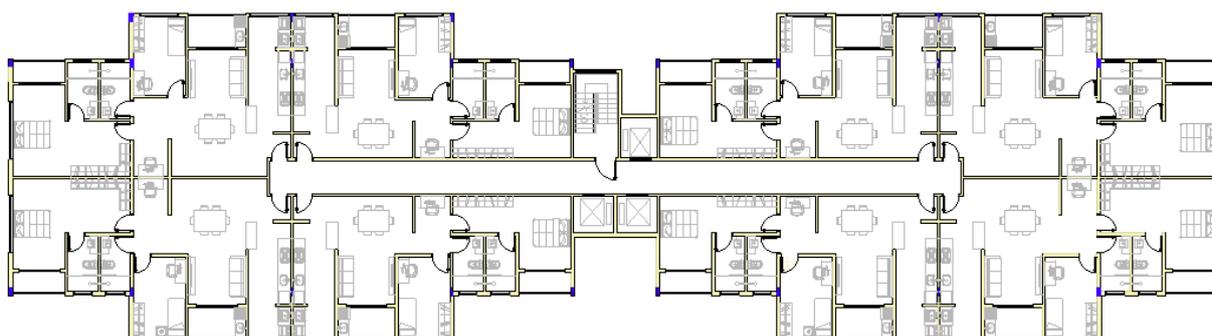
Pavimento Tipo Residencial 1º ao 10º (Produção da autora)
